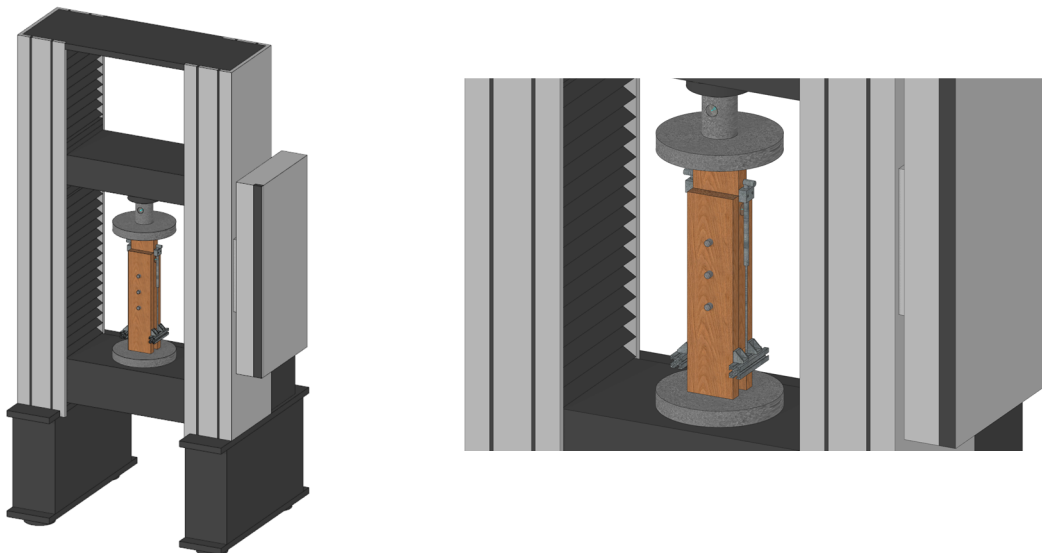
Disposition des assemblages sur la machine d'essais universel Zwick Z250.
